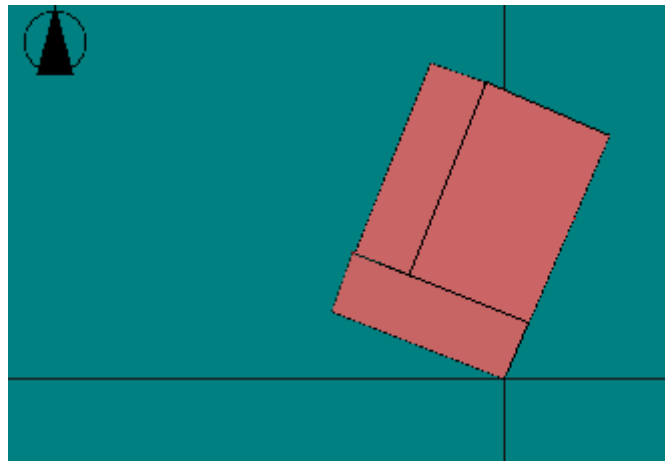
Planta de cubiertas de La Alquería del Moro modelizada en HULC. Fuente propia.
